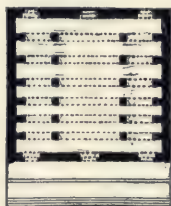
Kirche zu Schakka (Syrien). Grundriss.
